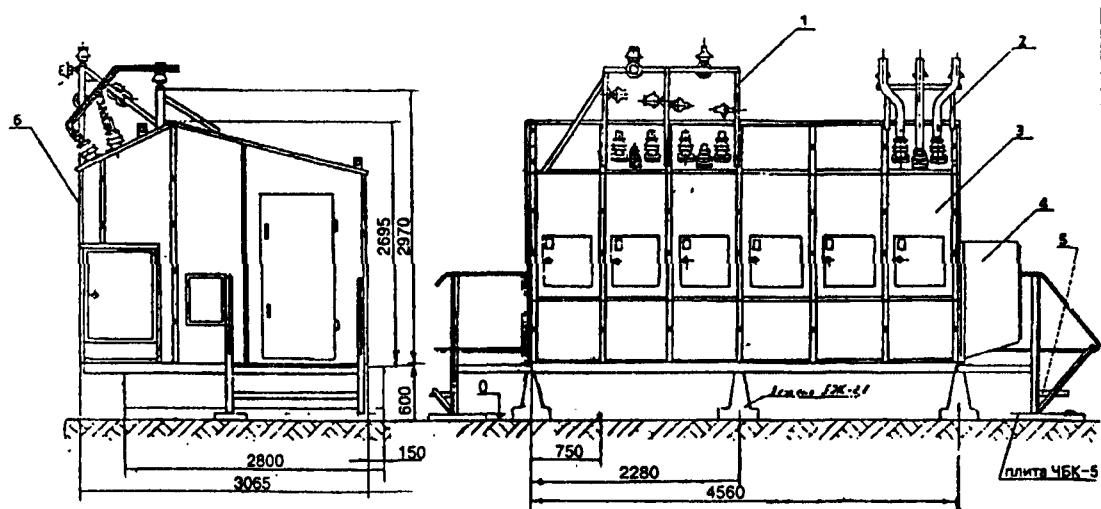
Общий вид блока КРУ исполнения У1 (вариант установки на незаглубленном фундаменте)
